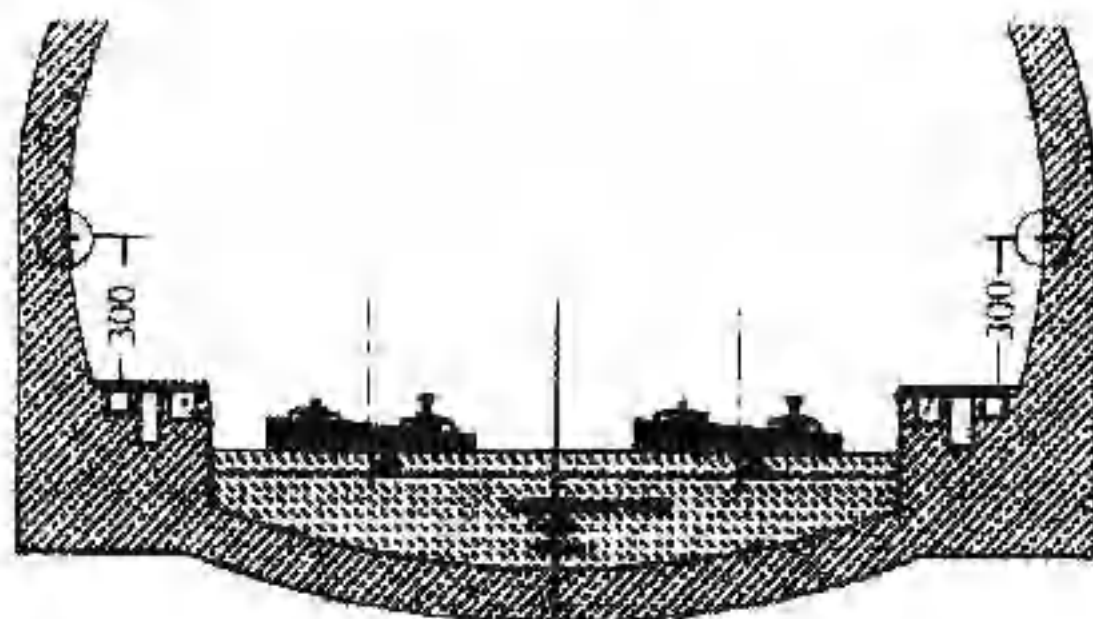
3 隧道内 CPⅢ埋设示意图 (单位: mm)
